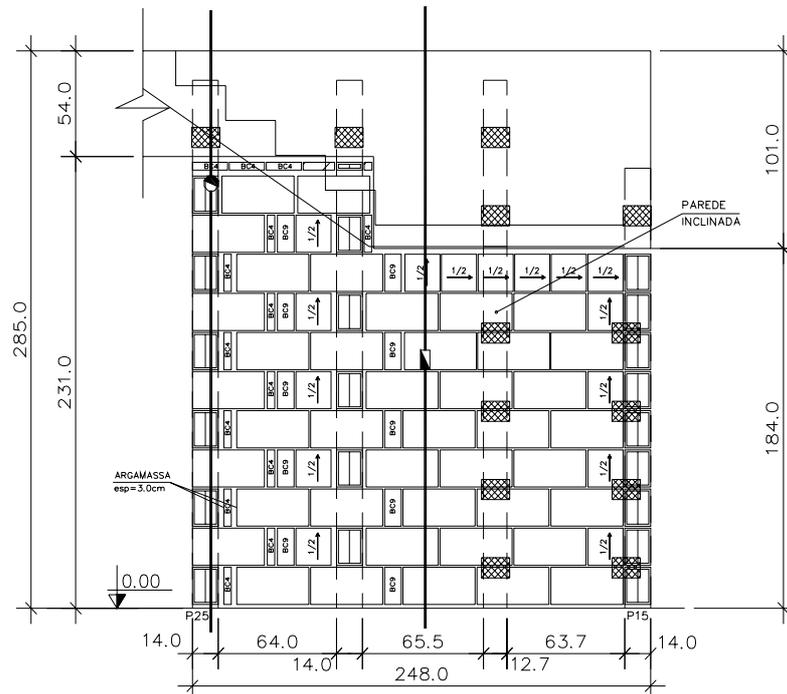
Elevação da parede lateral na entrada da escada revisada pelo projeto de vedação para o 1° ao 8° pavimento.
